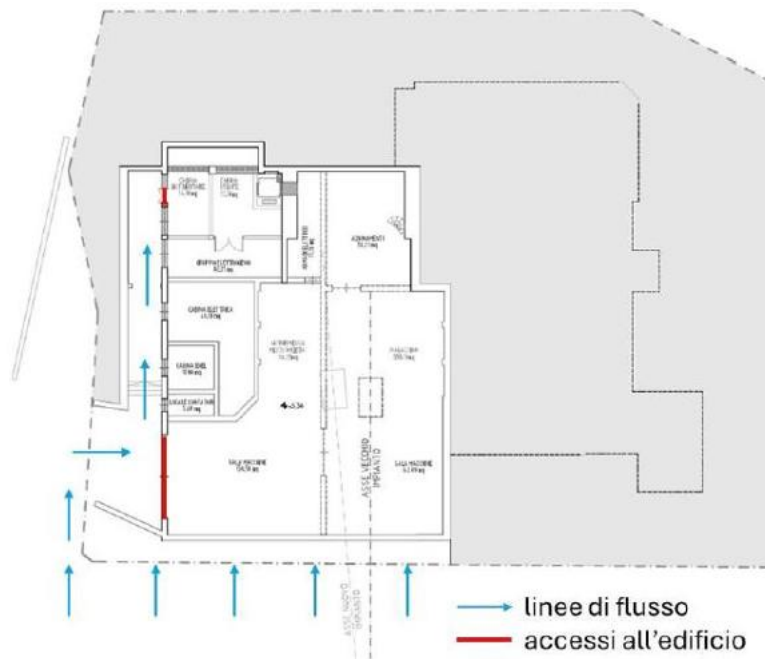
Schema di flusso in relazione alla pianta del piano interrato.
